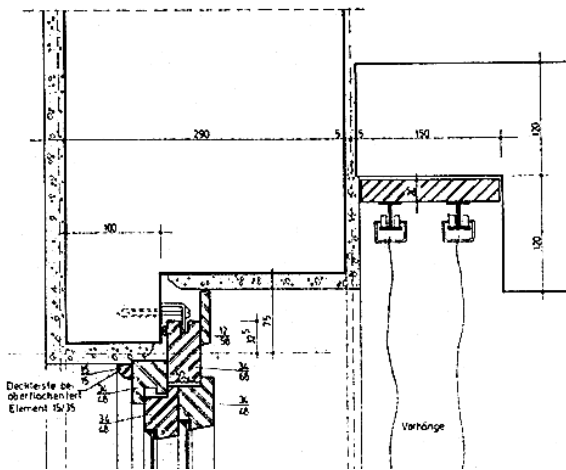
Fensteranschluss im Sturzbereich, konstruktionsbedingte Wärmebrücke
